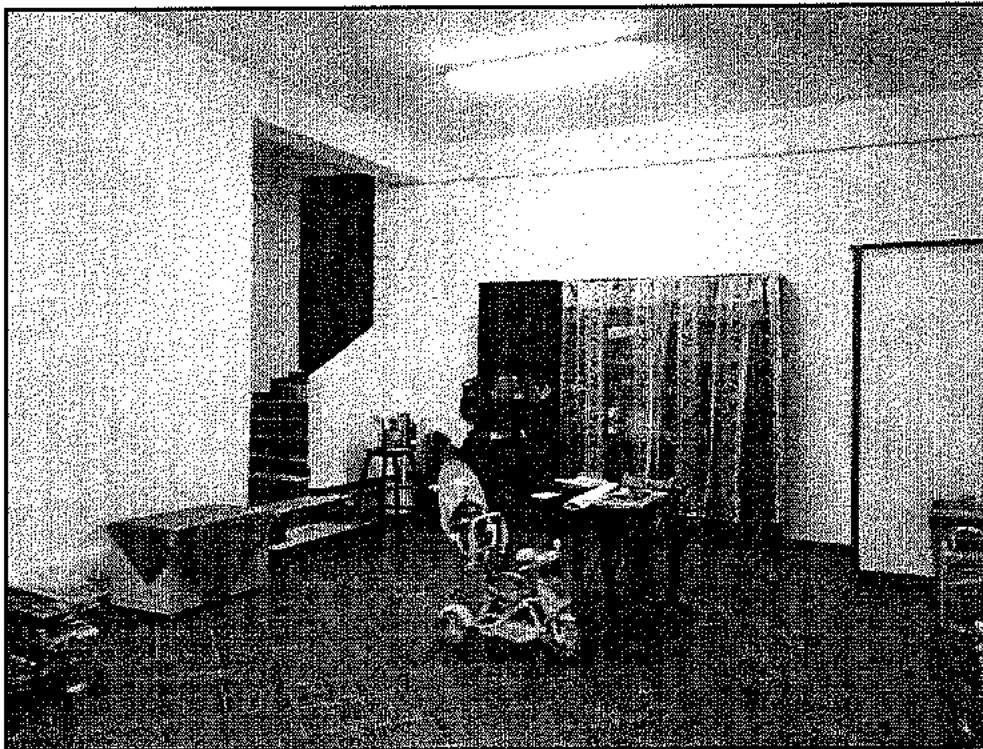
Sulla sinistra la rampa di accesso al vano scale principale
